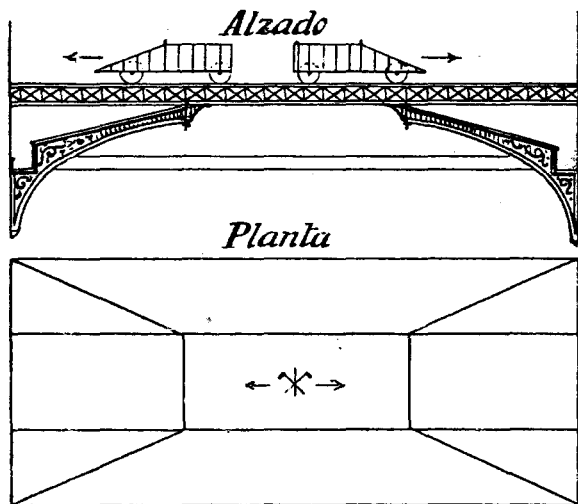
a 1134.—Armadura decorativa sobre planta cuadrada.
